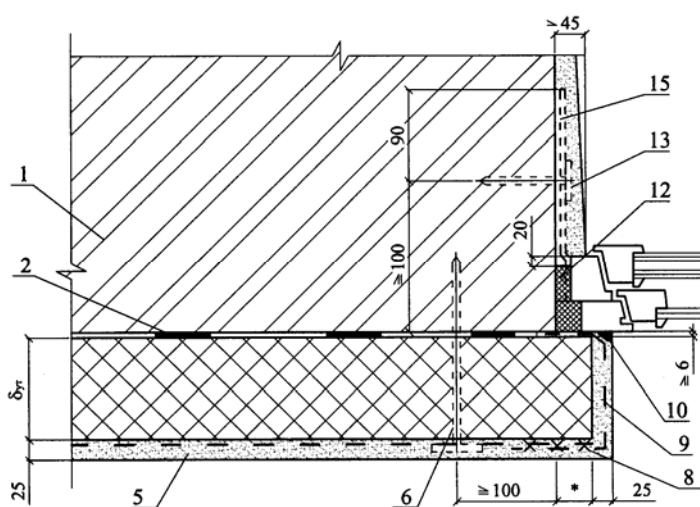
Поперечный разрез примыкания окна к стене (варианты)
